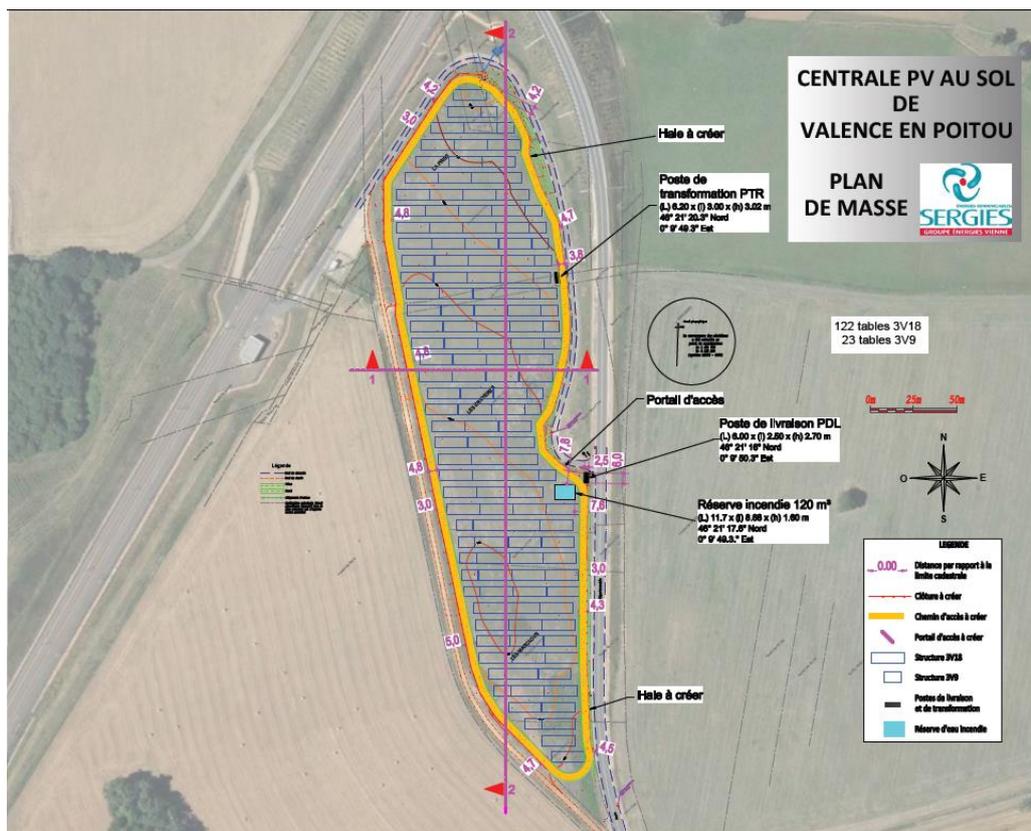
Plan d'implantation de la centrale photovoltaïque
